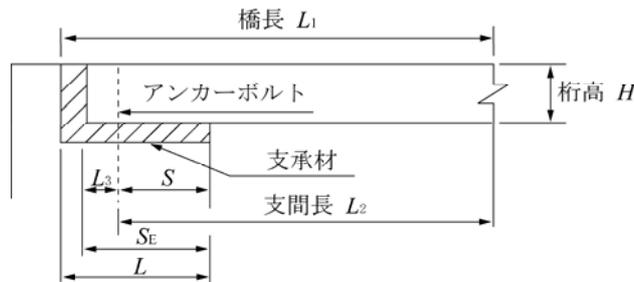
桁端から支承縁端までの距離(鉄筋コンクリート床版橋)
